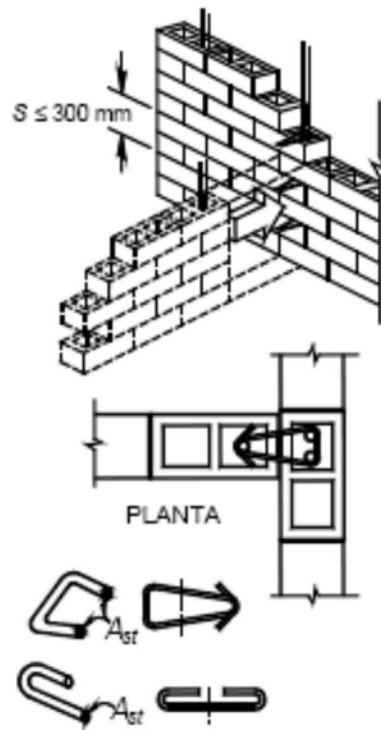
a) Requisitos para mampostería con refuerzo interior.
